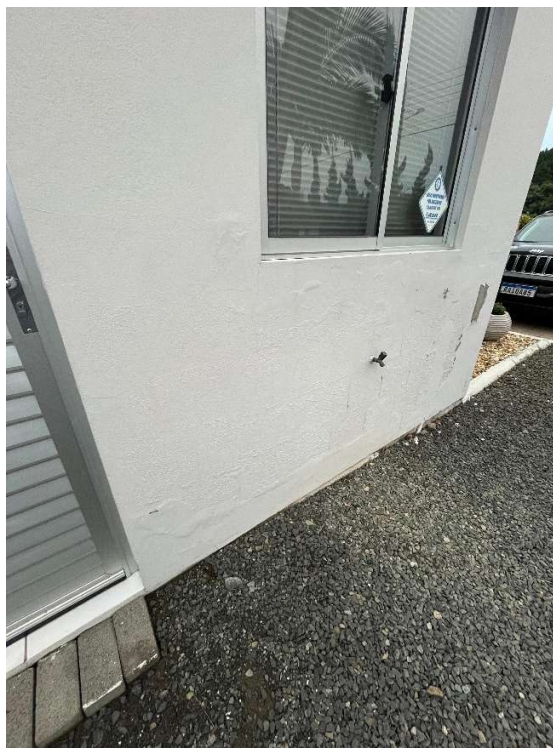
a 27 – Aberturas sem Vergas e Contravergas - Fonte: Acervo do autor, 2024
